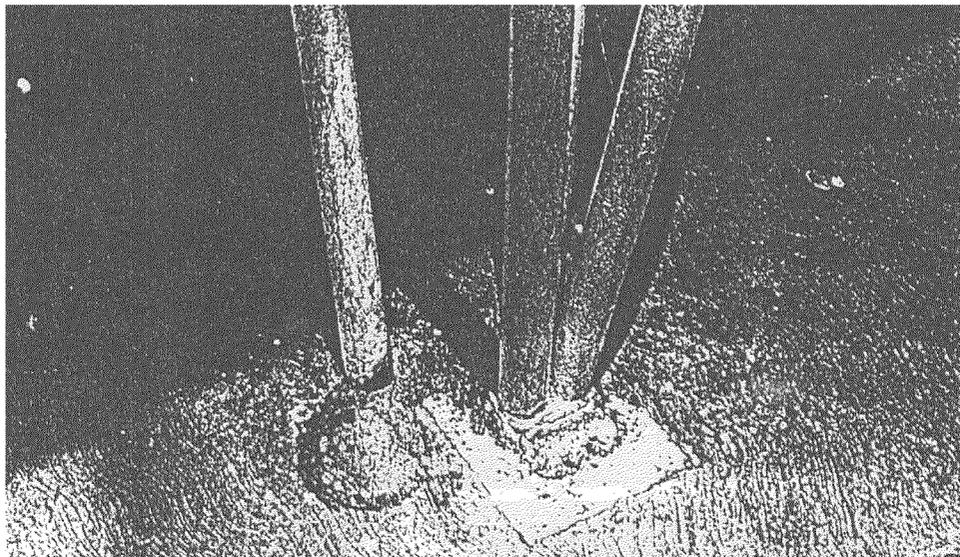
DETALLE DE LA BASE DE COLUMNA
